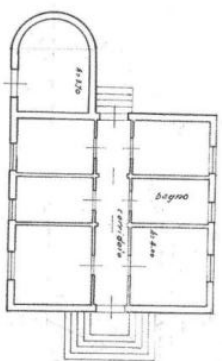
Fabbricato Port. 16. Planimetria Piano Terra
